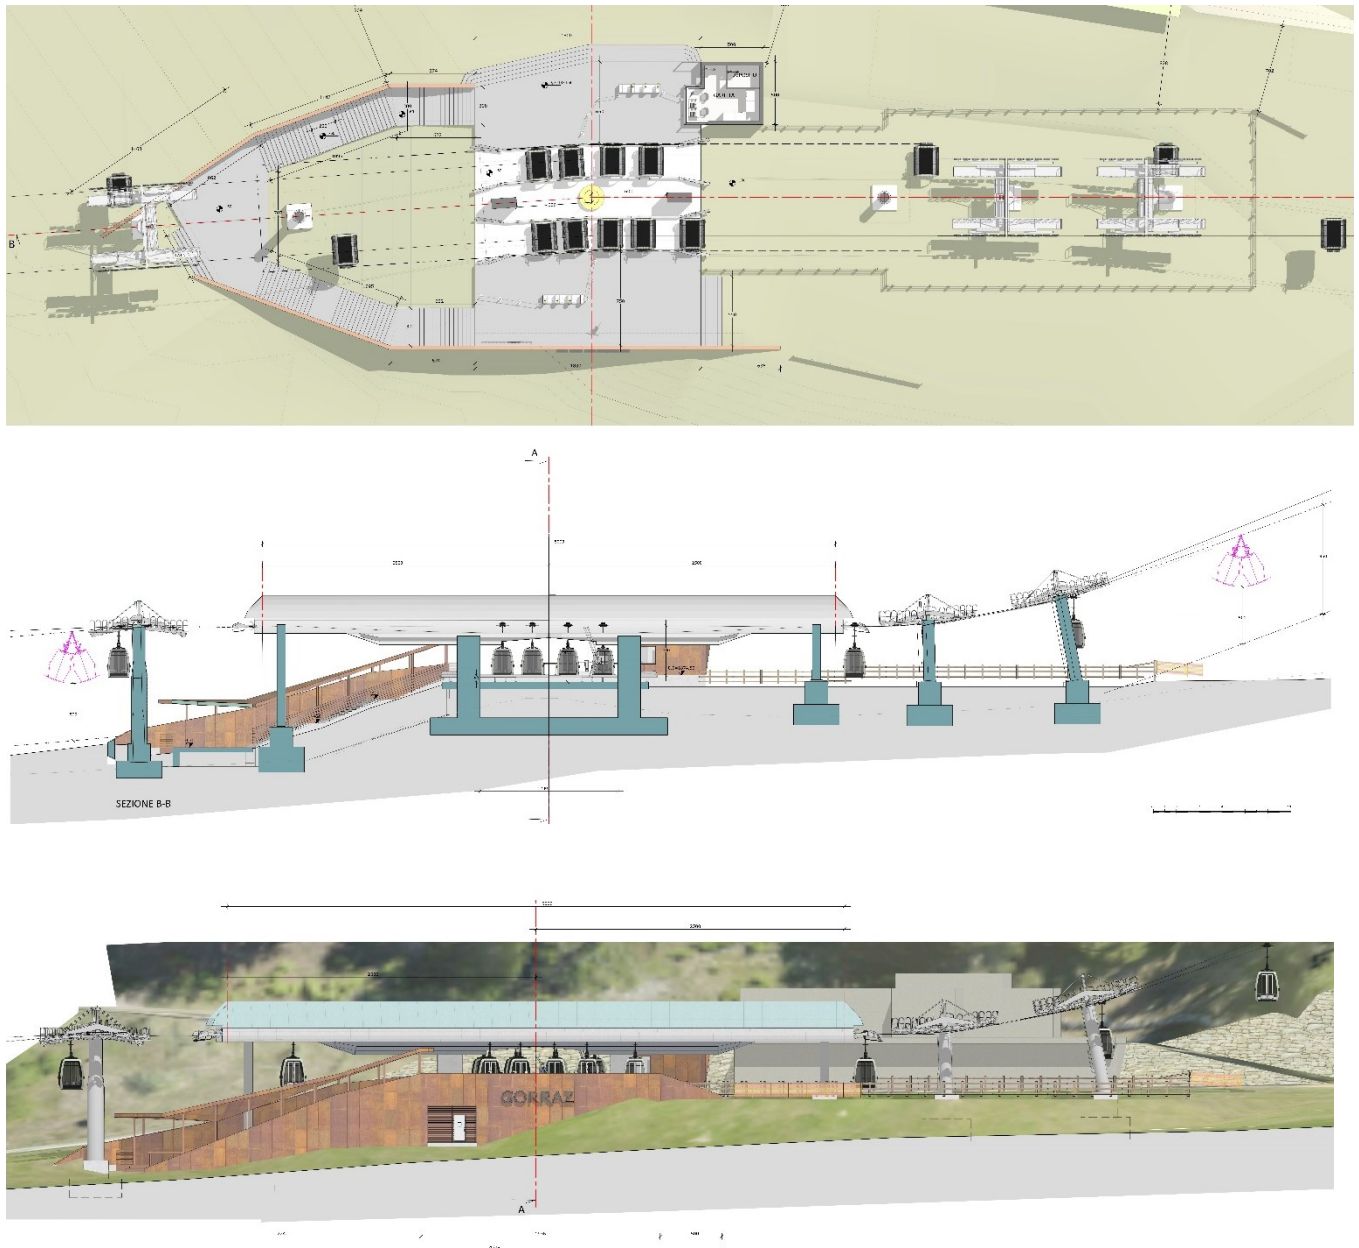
PIANTE E PROSPETTI NUOVA STAZIONE INTERMEDIA GORRAZ
